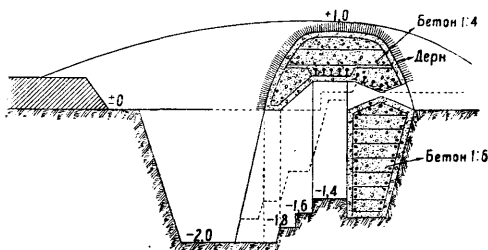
Простейший наблюдательный пункт из армированного бетона.
